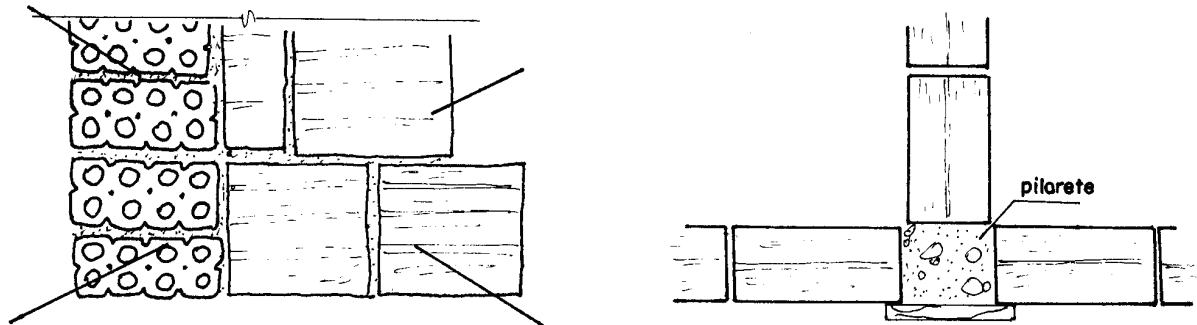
Exemplo de amarração nas alvenaria de tijolo furado
